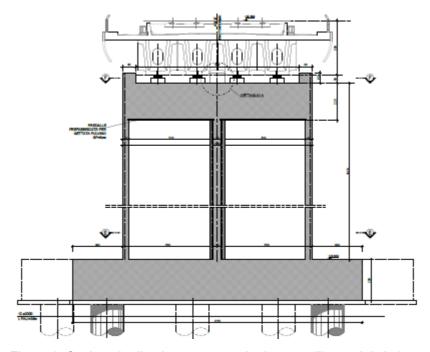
Sezione in direzione trasversale rispetto all'asse del viadotto
